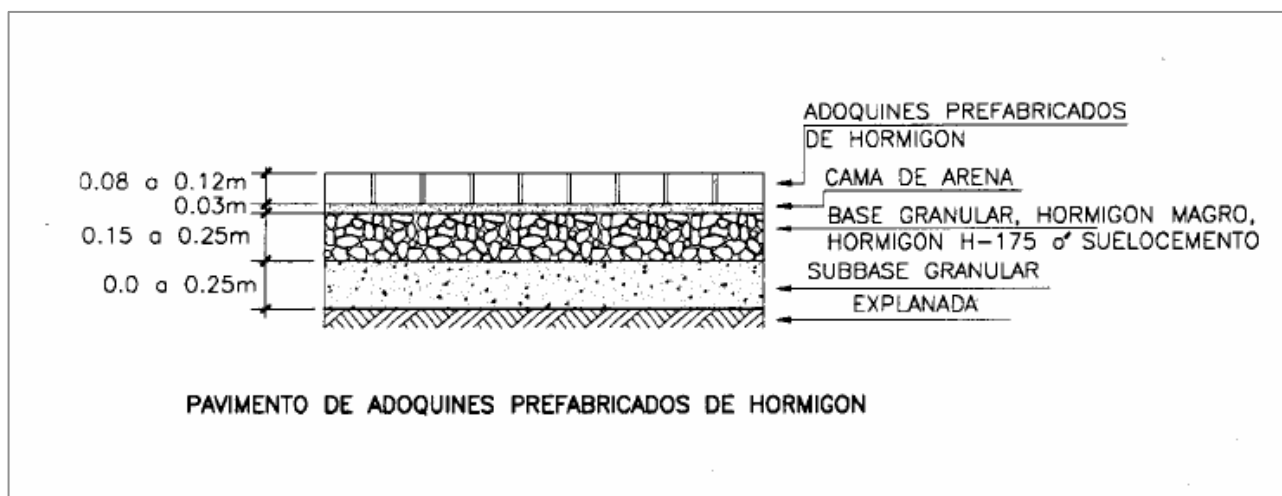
Pavimento de adoquines prefabricados de hormigón. Sección tipo
